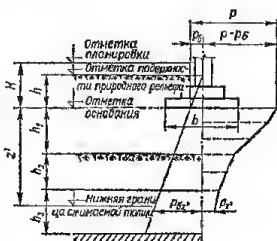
Расчетная схема распределения давления на горизонтальных сечениях в грунте ниже подошвы фундамента.
